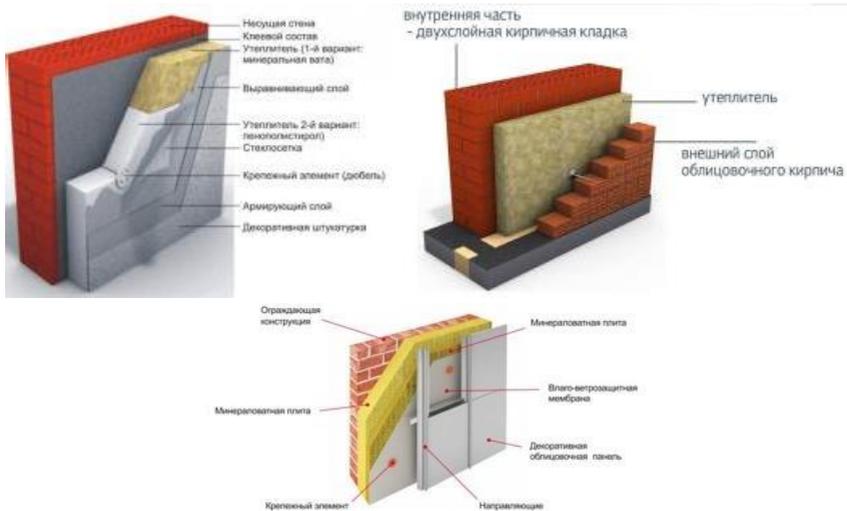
Виды внешних ограждающих конструкций. Стена двухслойная, трёхслойная, с вентилируемым фасадом.
